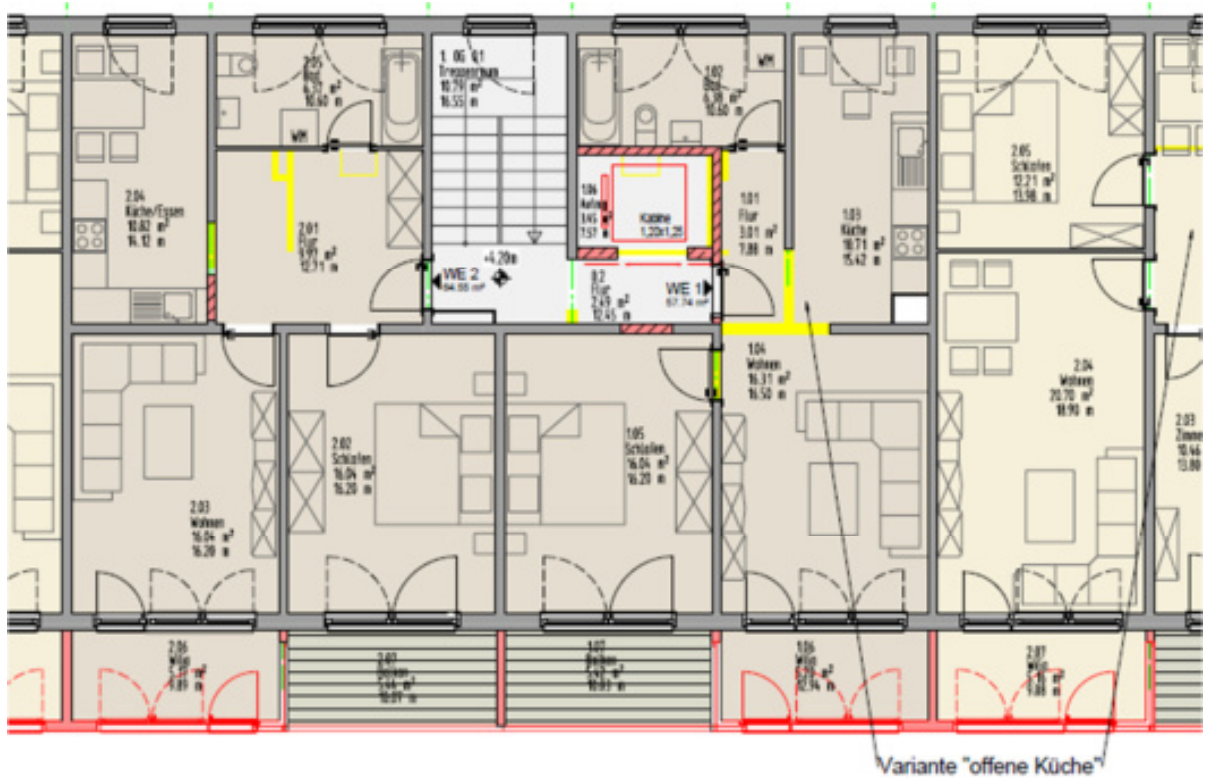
Ausschnitt aus Grundriss zu Var 2 mit Grundrissoptimierung für innliegenden Aufzug (Quelle: IBNuP)
